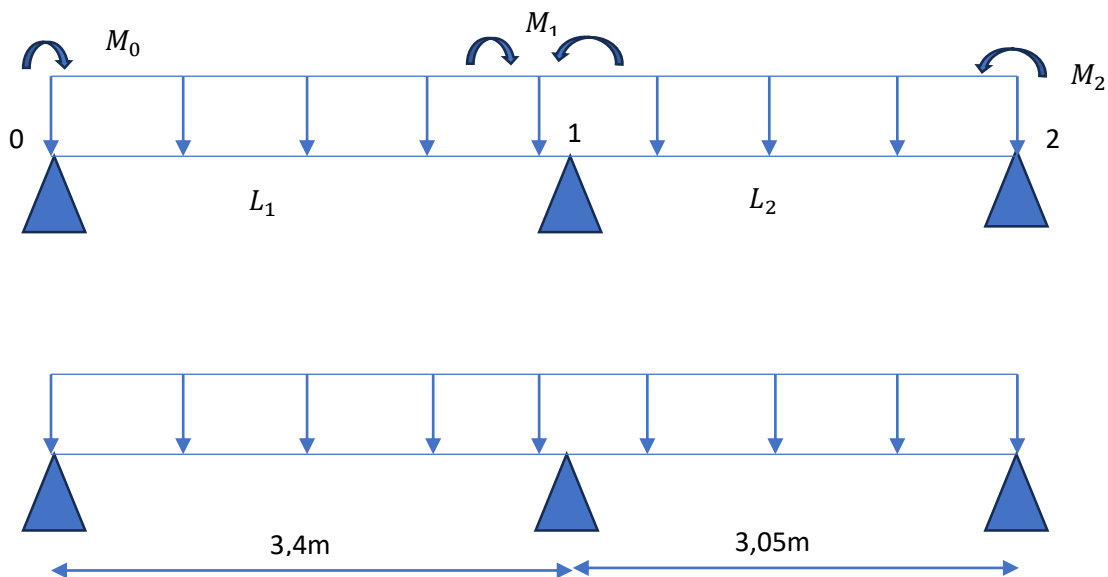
Schéma statique de la poutrelle type 1 plancher étage courant
